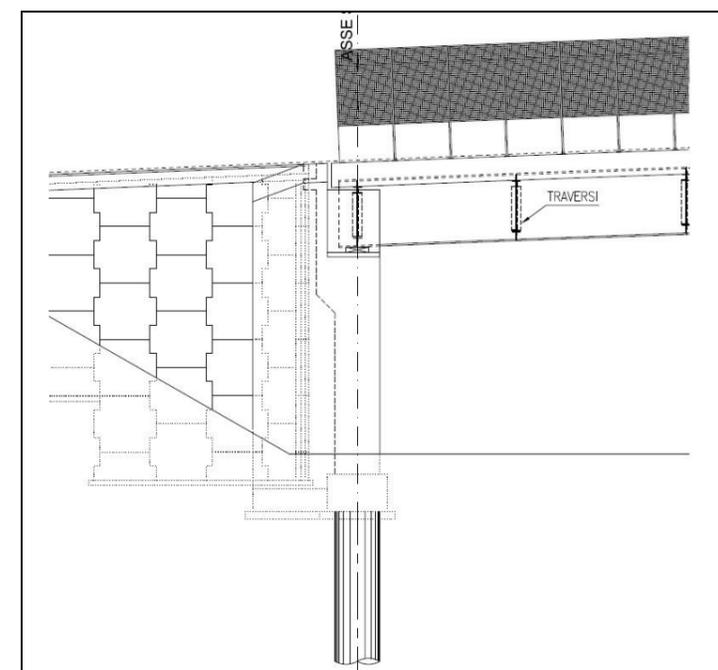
Particolare della fondazione della spalla dei cavalcavia
